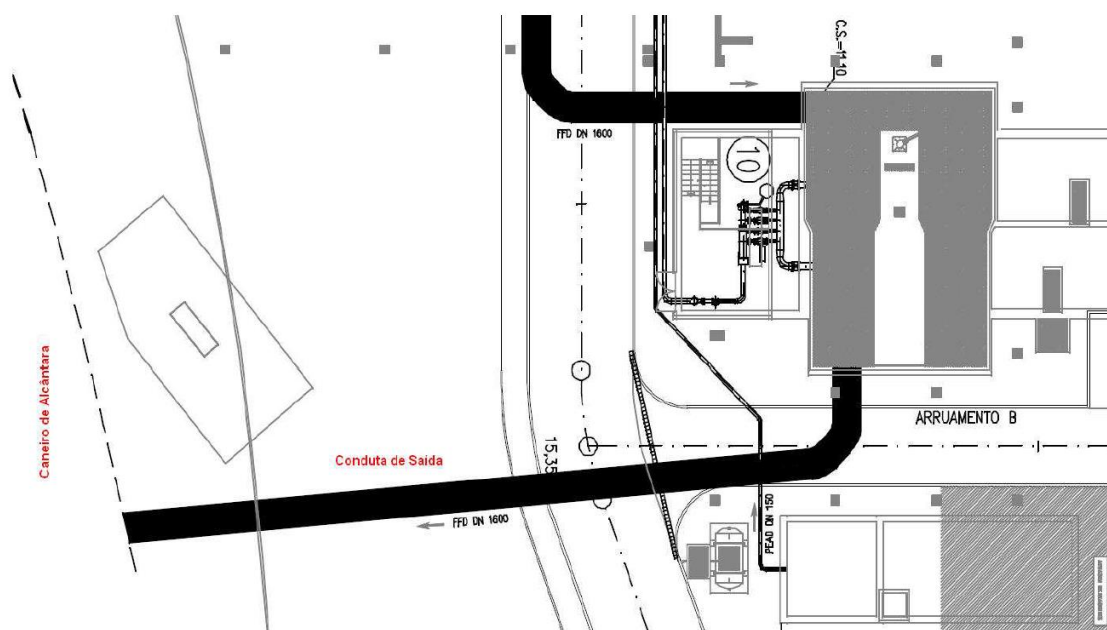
Planta da descarga da ETAR de Alcântara.
